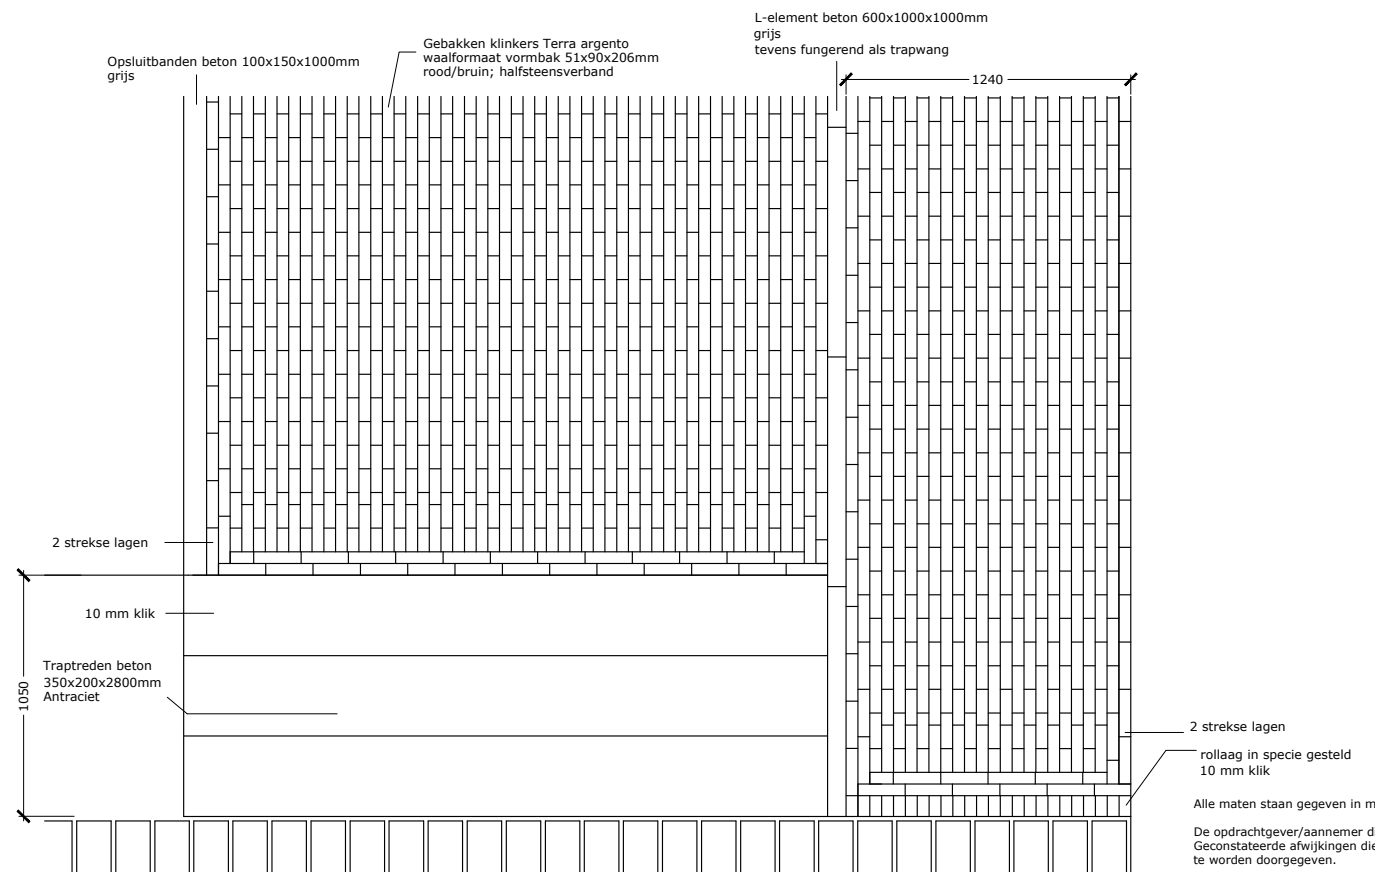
Bestratingsdetail van de overgang van het plein naar de vlonder. Origineel op schaal zit in de bijlage van dit rapport.
